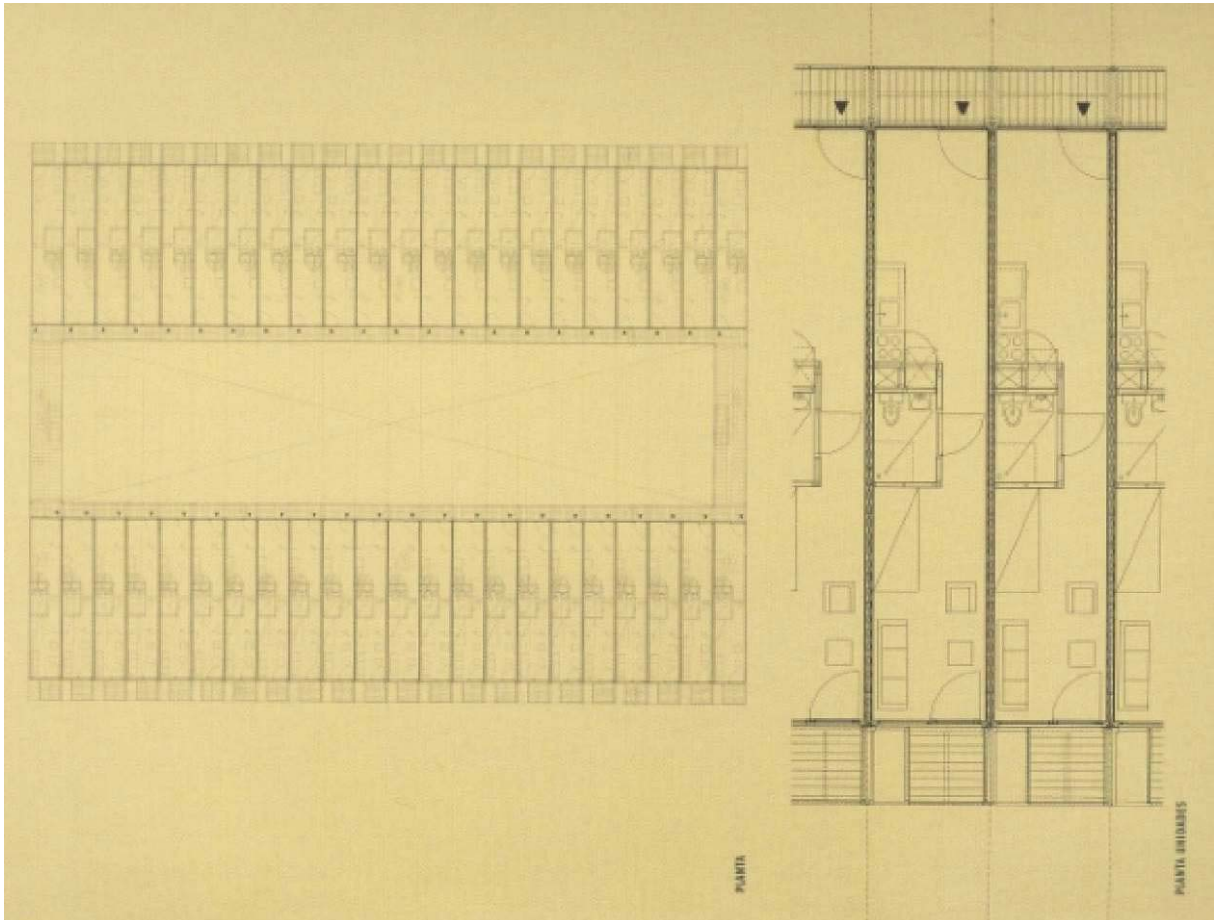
Planta (s/escala). Keetwonen (Slawik 2010).
